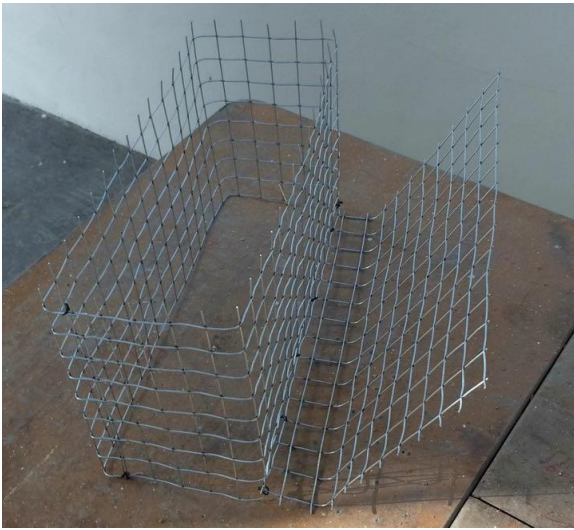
Armadura com tela metálica tipo malha 25x25x1.2mm
